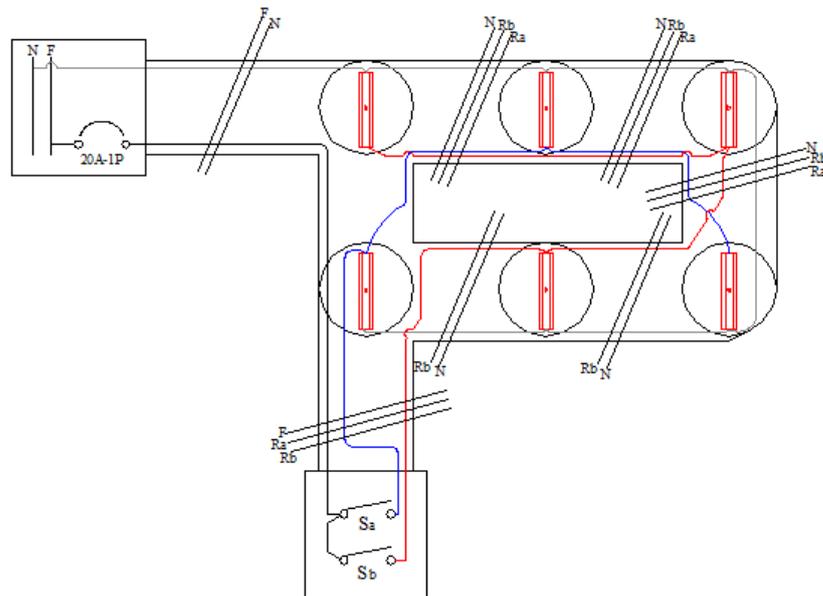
ESQUEMA DE EMPLAZAMIENTO O DE ALZADO
